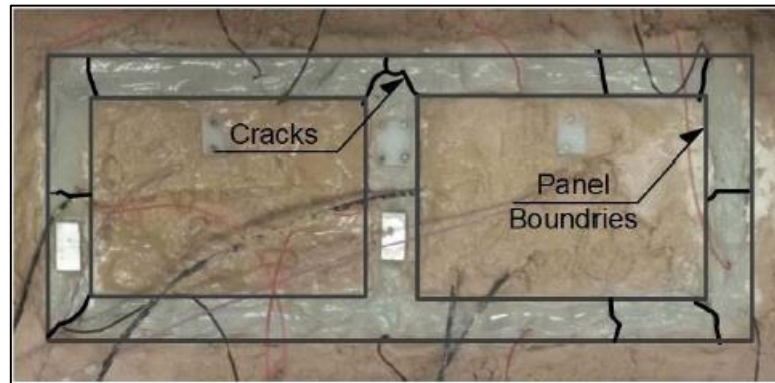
Grietas en rejilla de suelo cemento
